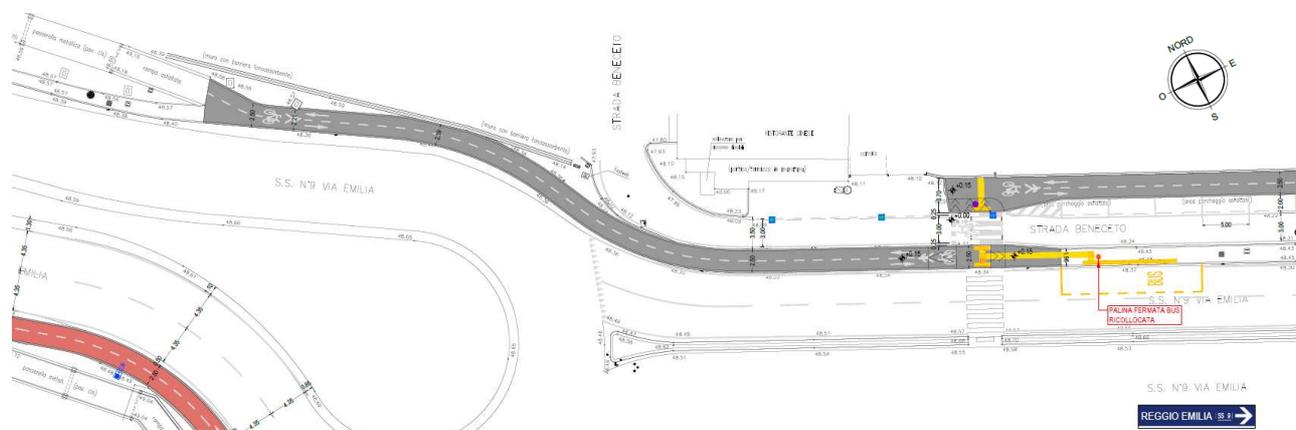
La pista ciclopedonale su SS9 Via Emilia e Strada Beneceto
